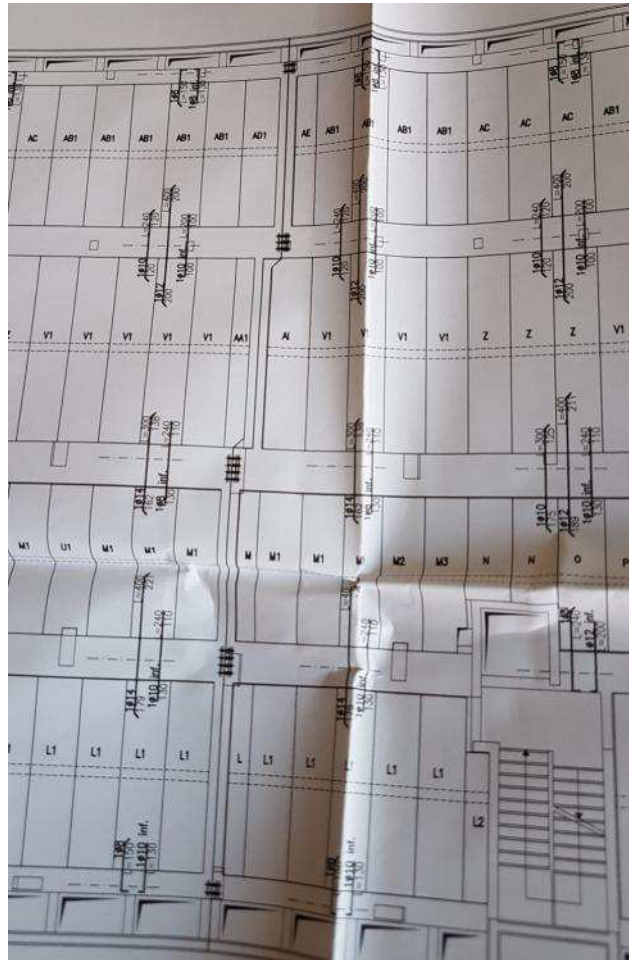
stralcio pianta piano tipo presenza collocazione giunti
